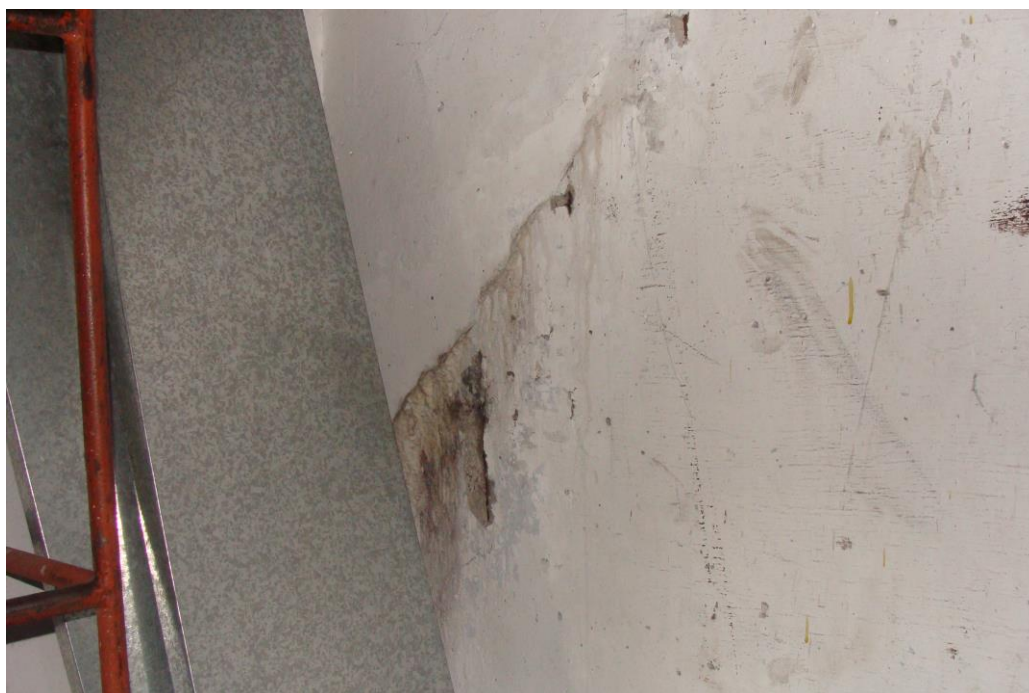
Fissura na parede da caixa d'água (19/11/2013)
